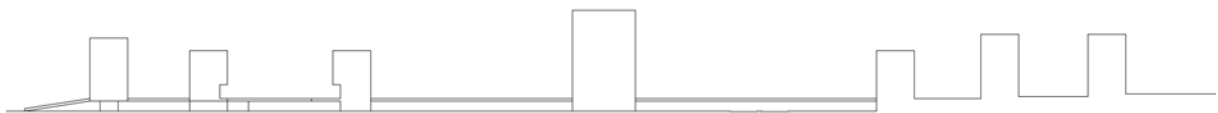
Corte 2 Novo edificado (Fonte: Autor)
